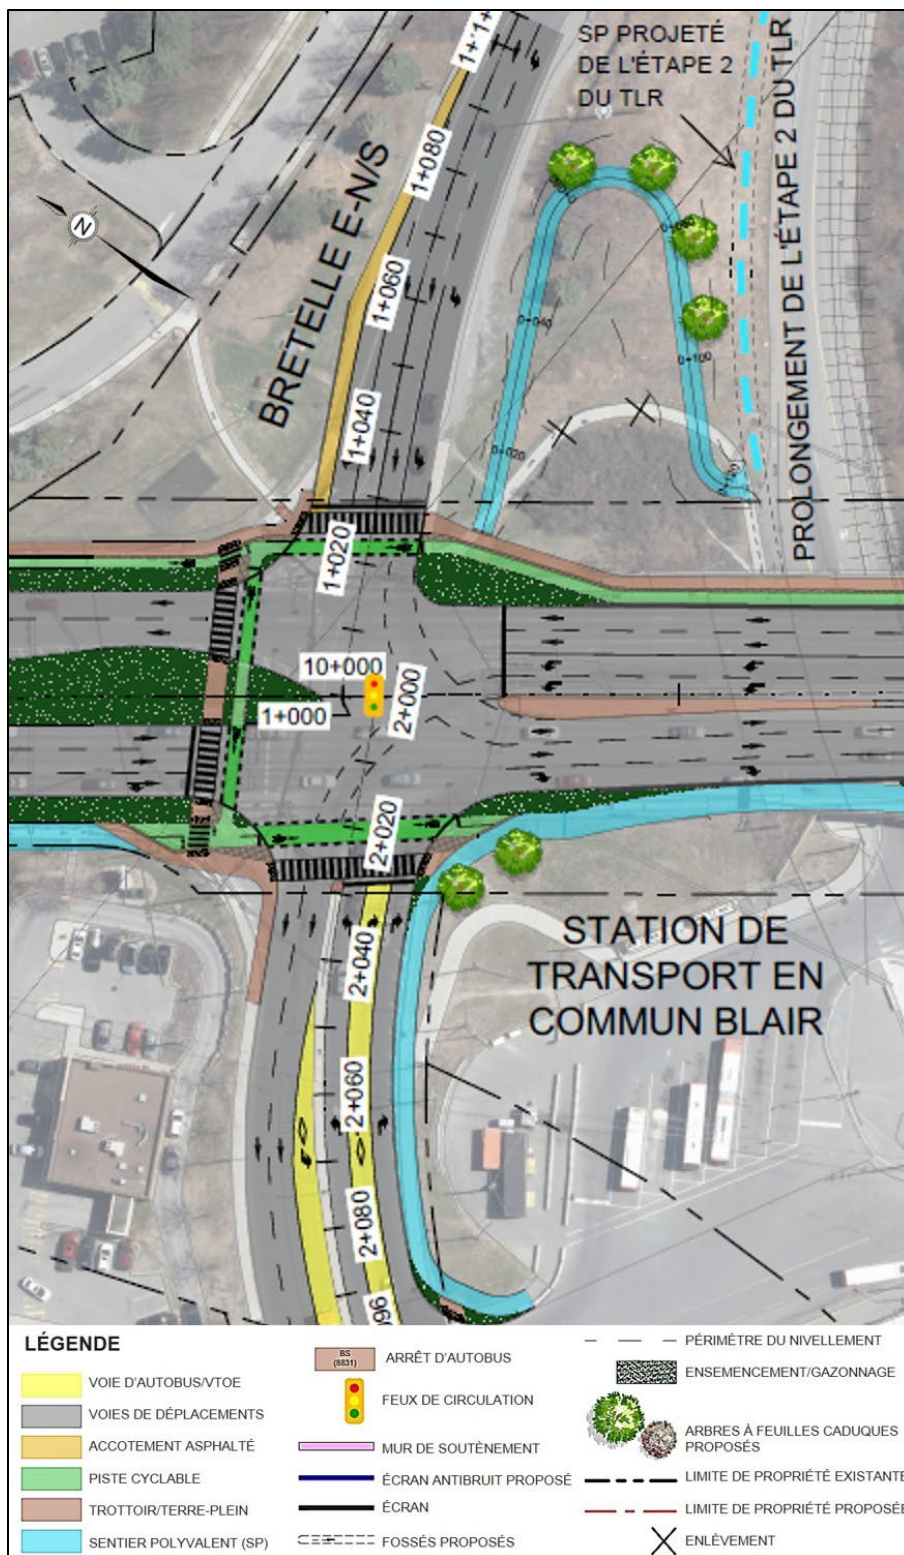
Intersection protégée et faits saillants des travaux d'aménagement de la station Blair
